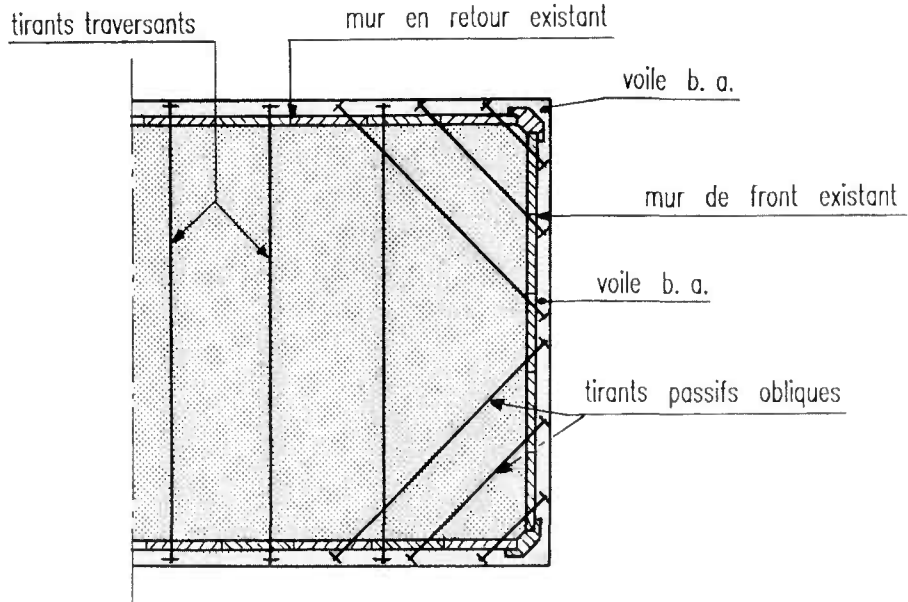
Mur de front d'une culée renforcé par un voile en béton ancré sur les voiles latéraux des murs en retour
